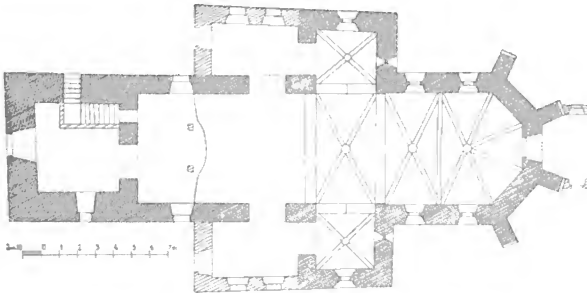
Kosteletz. Grundriss der Kirche.
